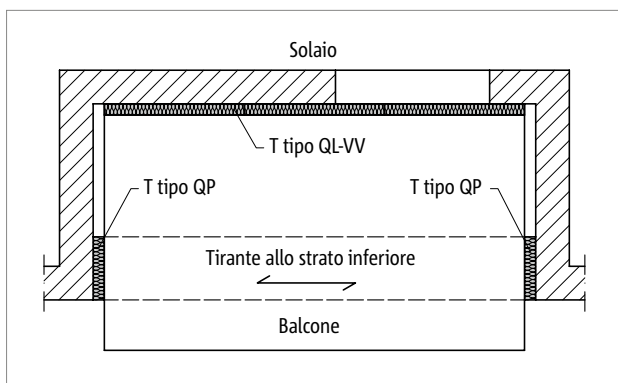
Schöck Isokorb® T tipo QL-VV e QP: loggia con appoggio su tre lati
